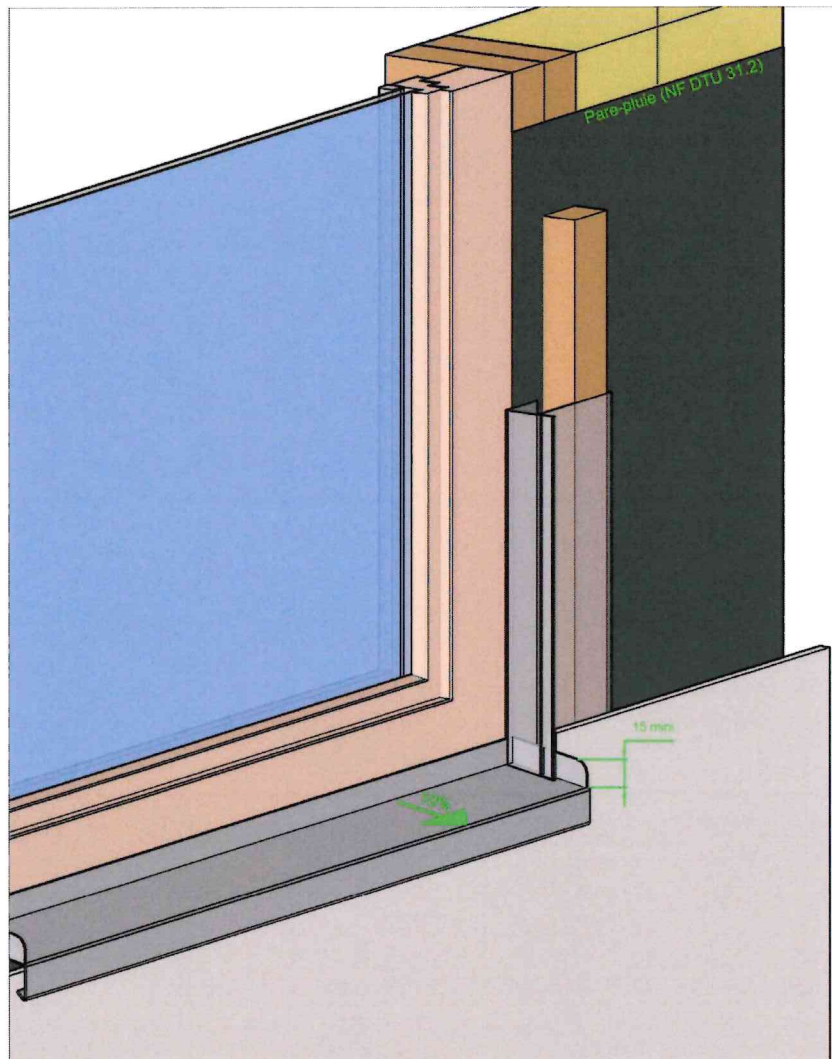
Pose sur COB - Coupe sur tableau de baie
